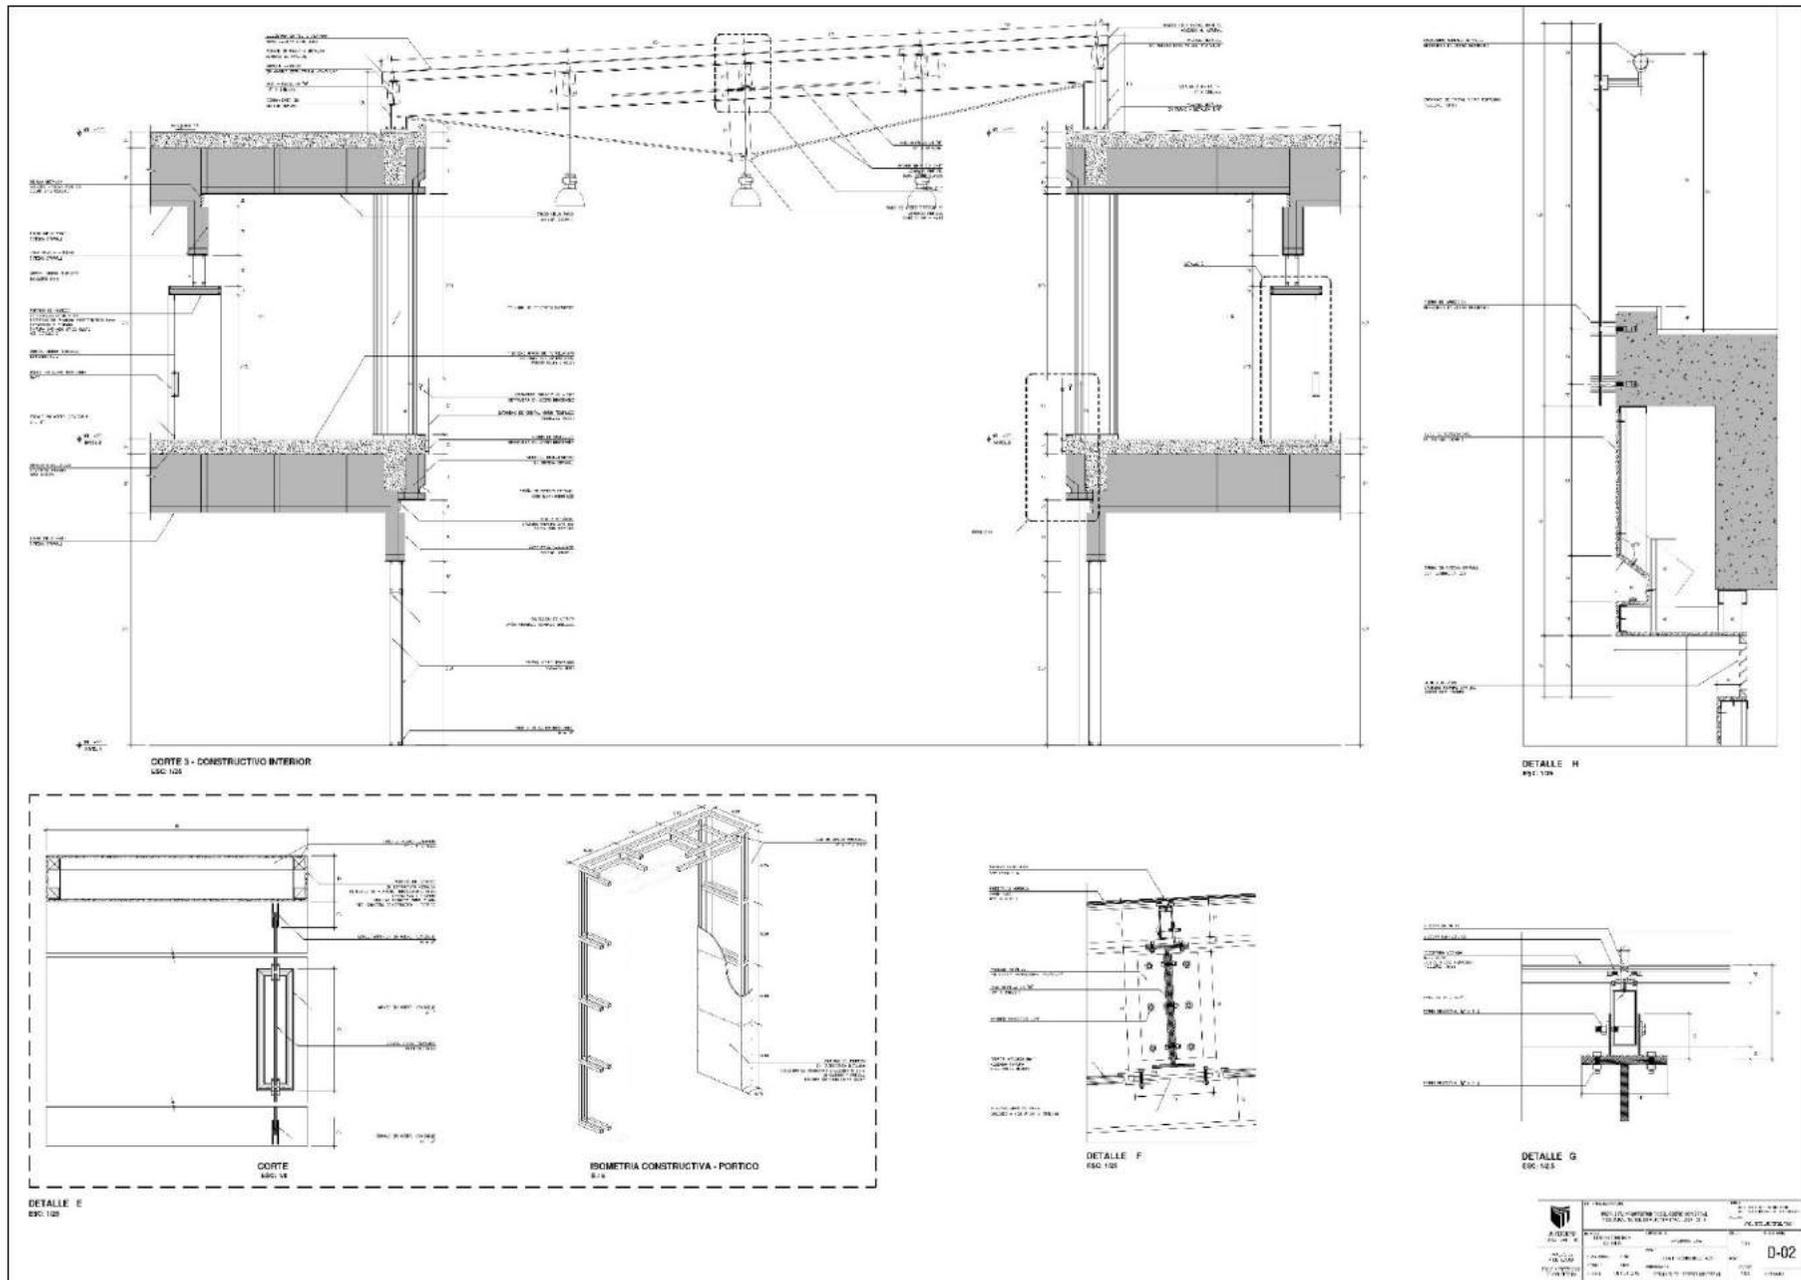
Detalles constructivos – zona comercial. Elaboración propia.
